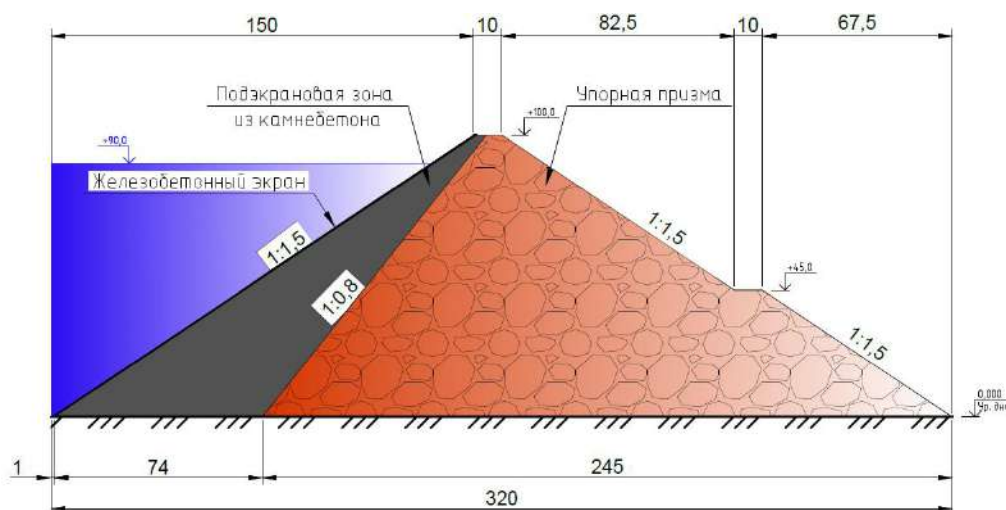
Каменно-набросная плотина с железобетонным экраном с подэкрановой зоной из камнебетона
